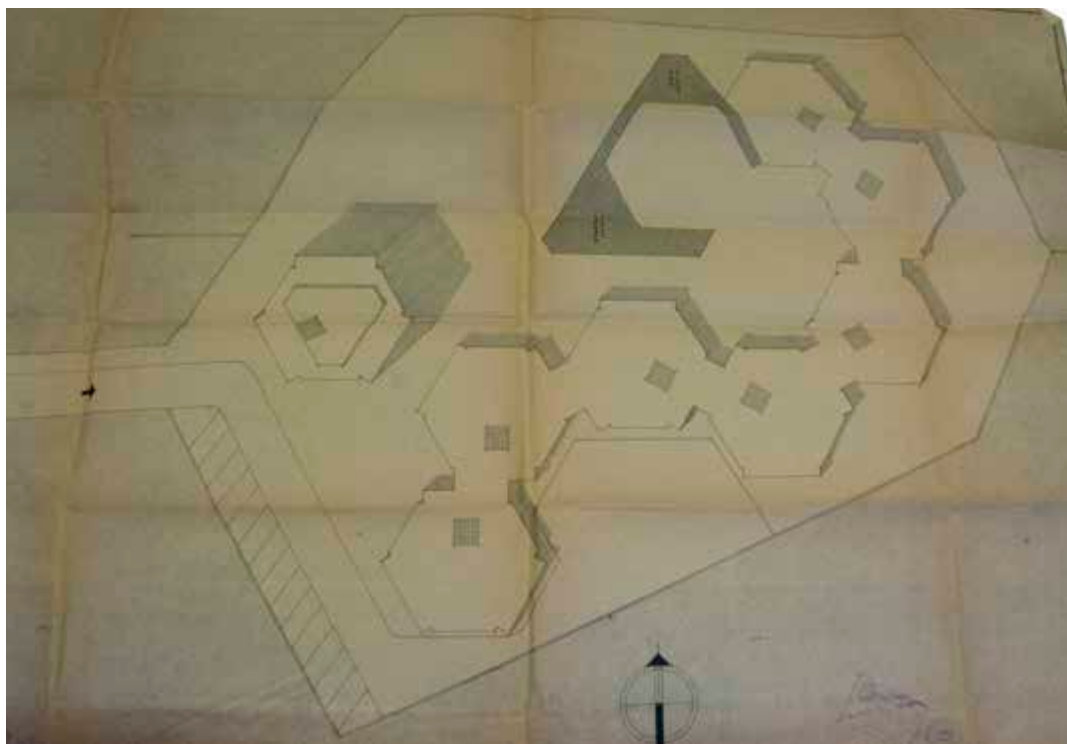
Plano del proyecto original edificio Hexagonal. Antonio Bonet Castellana. Plano de cubiertas y general de plantas bajas. Escala original 1/200. Fuente: Archivo Municipal de Cartagena.
